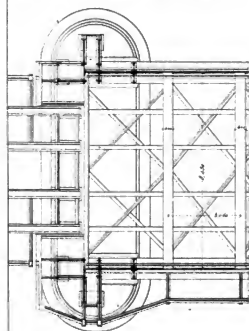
Elevation sur une pile côté de la passerelle (Amont)
